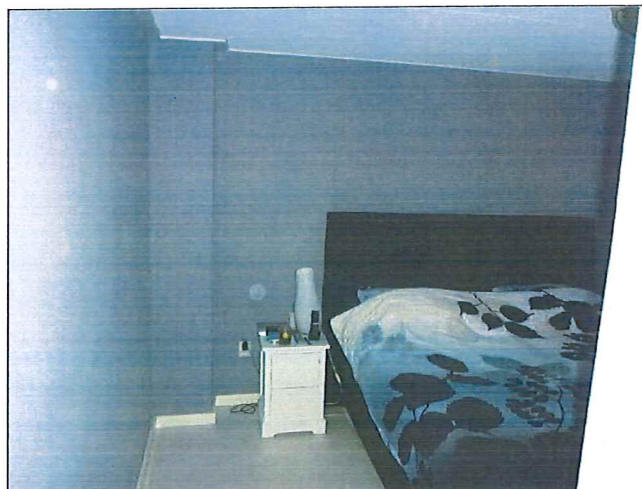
Slaapkamer: Vloerafwerking (Niet asbestverdacht)
